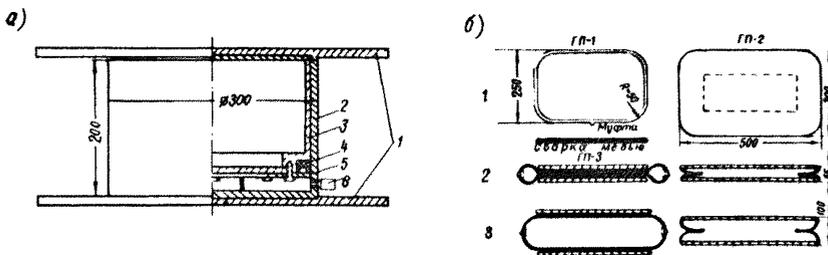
Гидравлические домкраты для натуральных испытаний:
